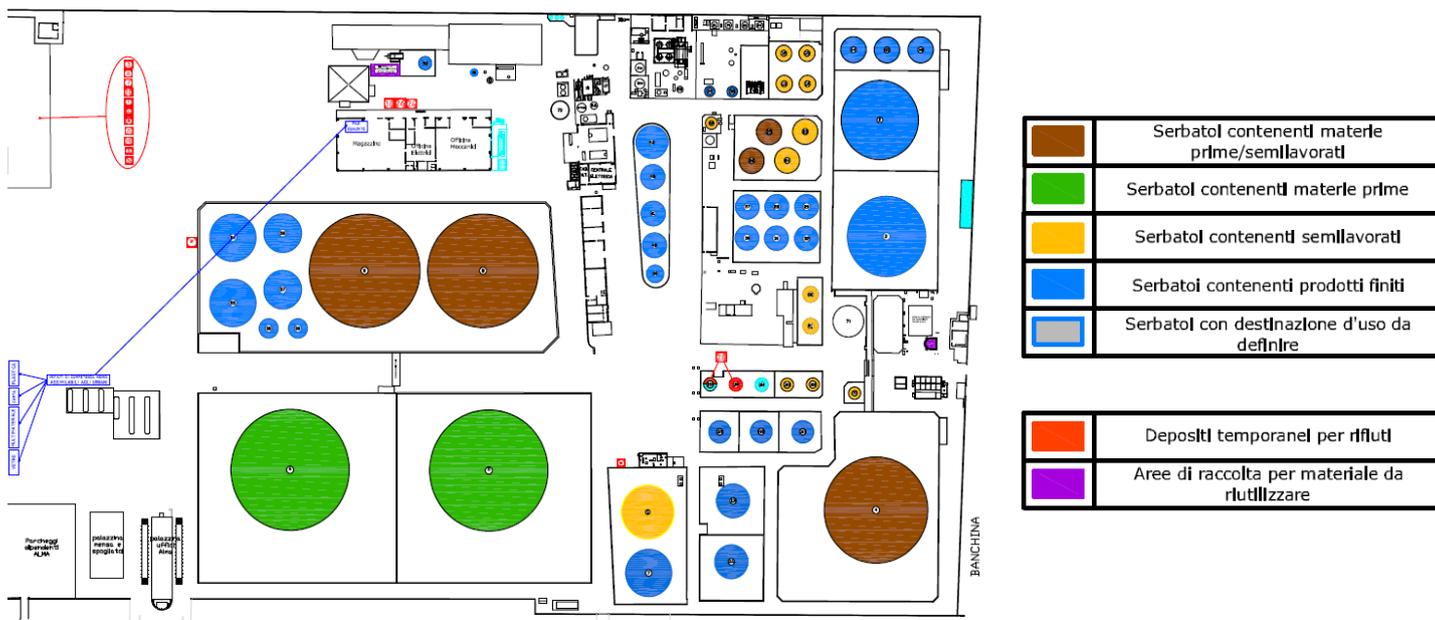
Estratto planimetria della disposizione serbatoi nello stabilimento Alma Petroli
